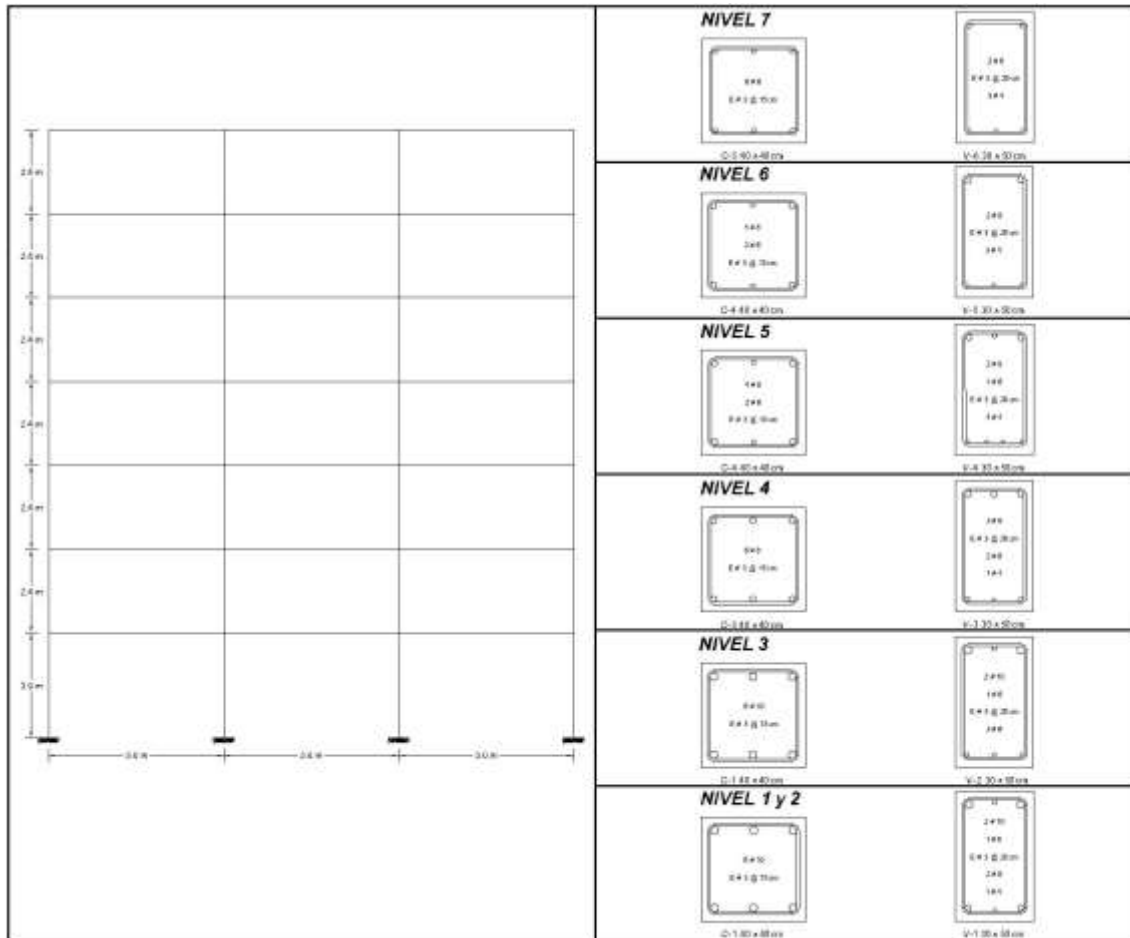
Armado de vigas y columnas para MCR de 7 con MDL diseñadas con el RCDF-2004 (GDF, 2004)
